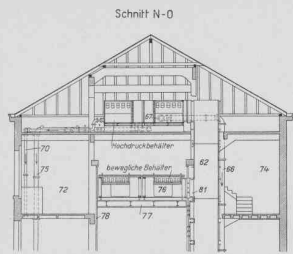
Längsschnitt durch den Nordflügel (vergl. den darunterstehenden Grundriss Abb. 11).
